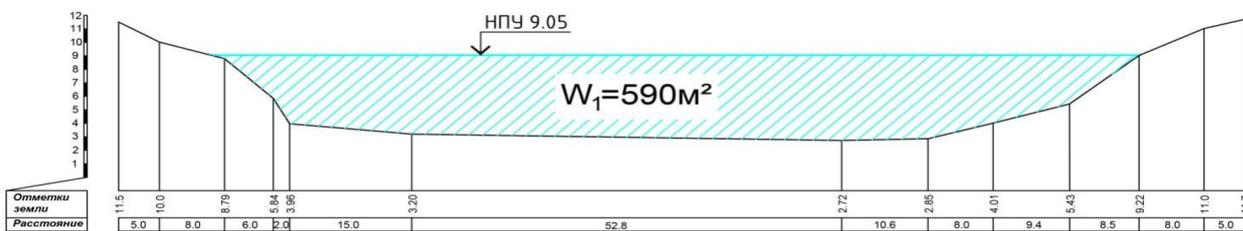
Поперечник № 1 русла реки Большой Узень. Расстояние до водосбросного сооружения 45 км.
